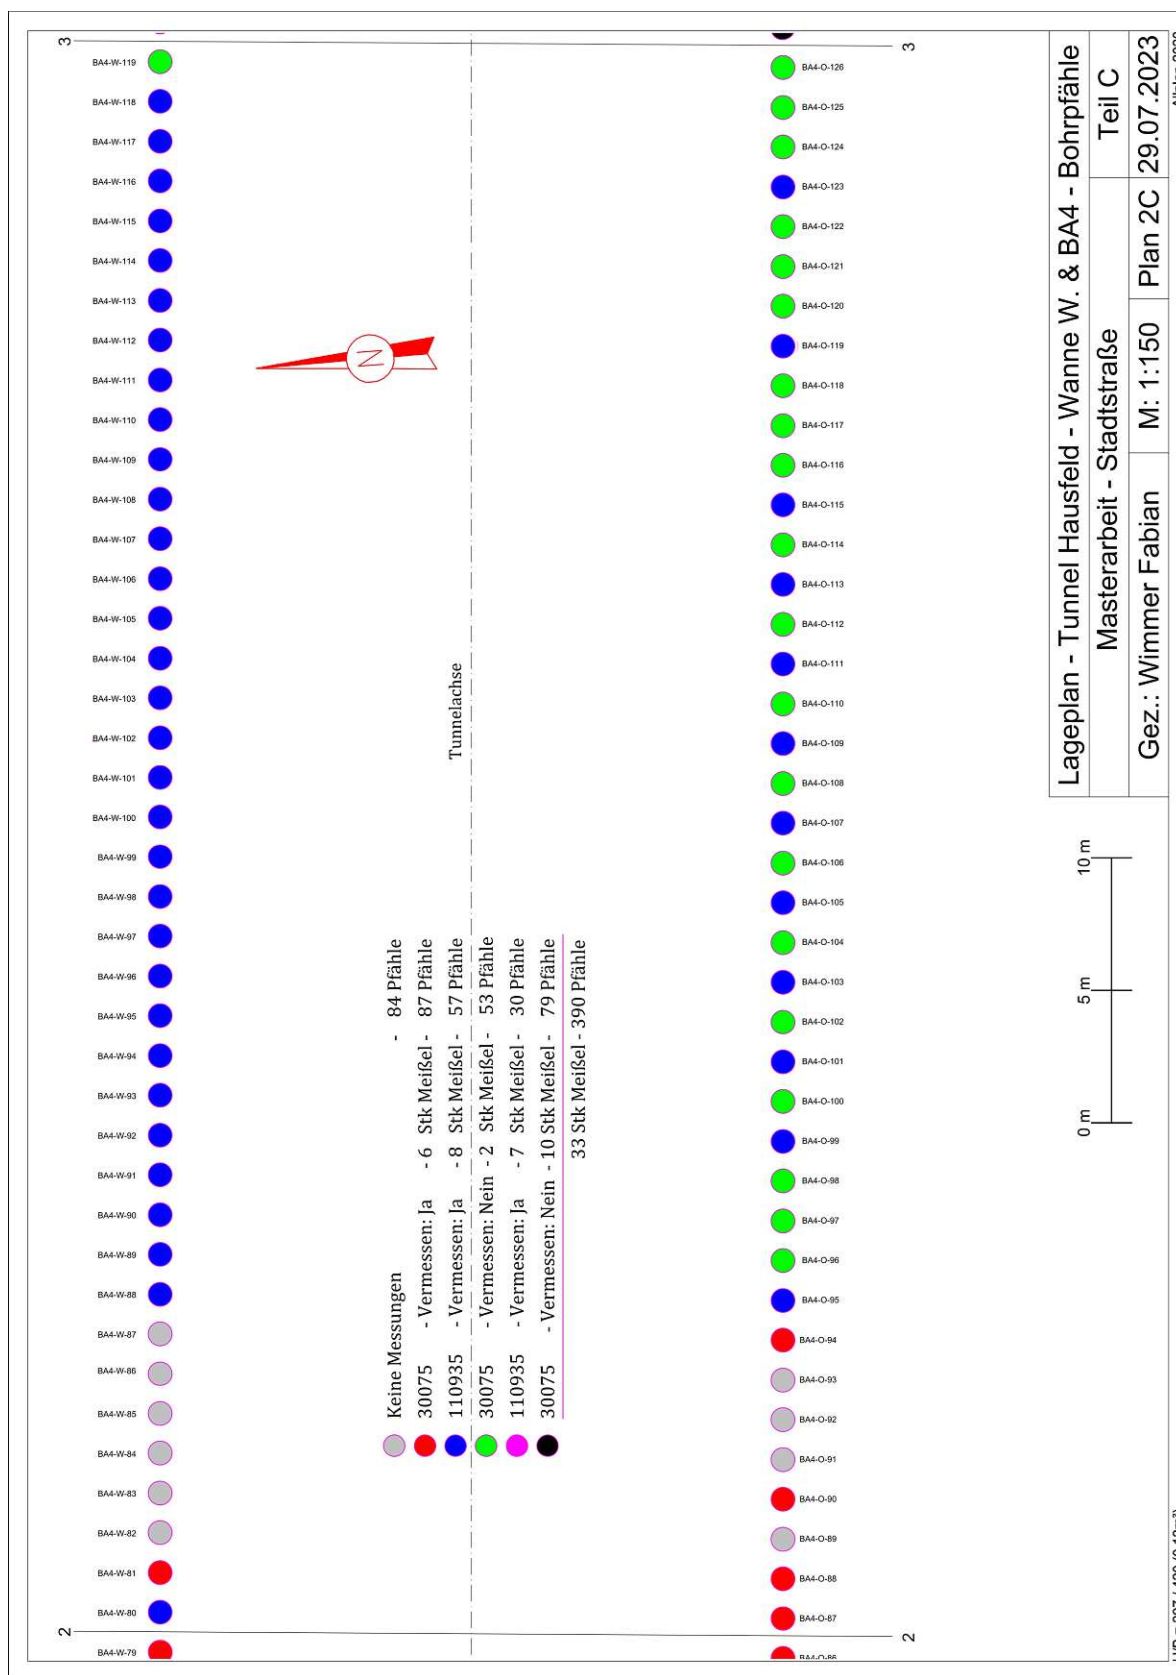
Lageplan - Tunnel Hausfeld, Wanne West und BA4 - Detailansicht Plan 2C; Plangrundlage [15]
